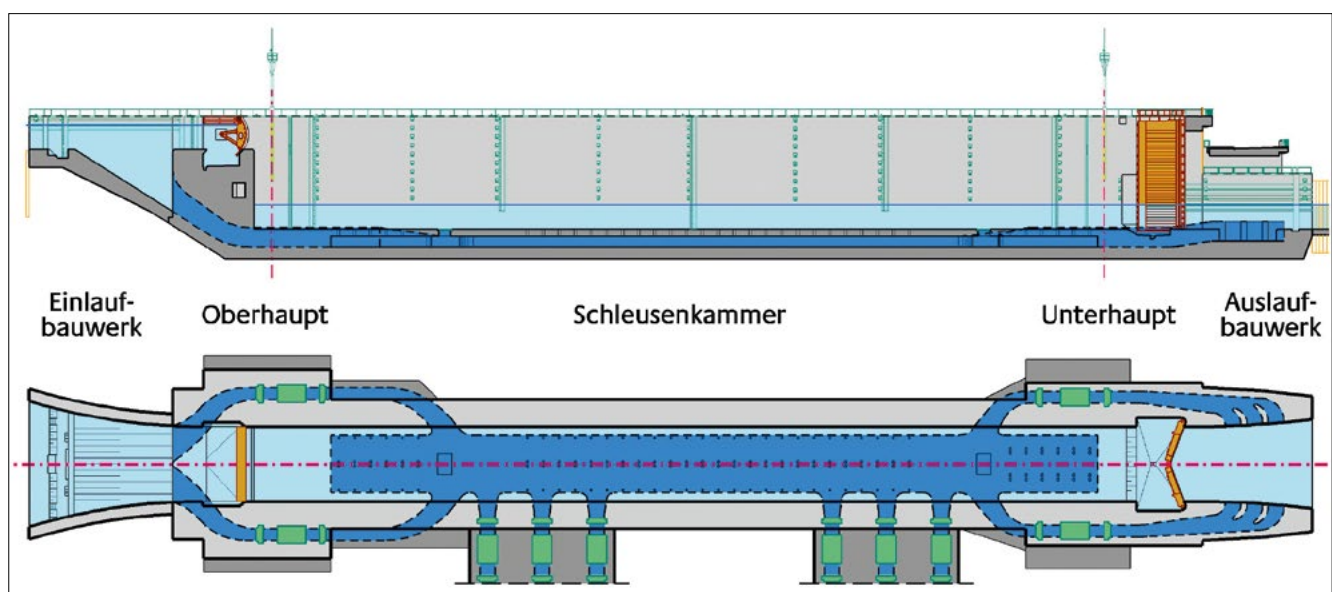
Schleusenansicht und -draufsicht mit Grundlauf und Zulaufkanälen (dunkelblau)
